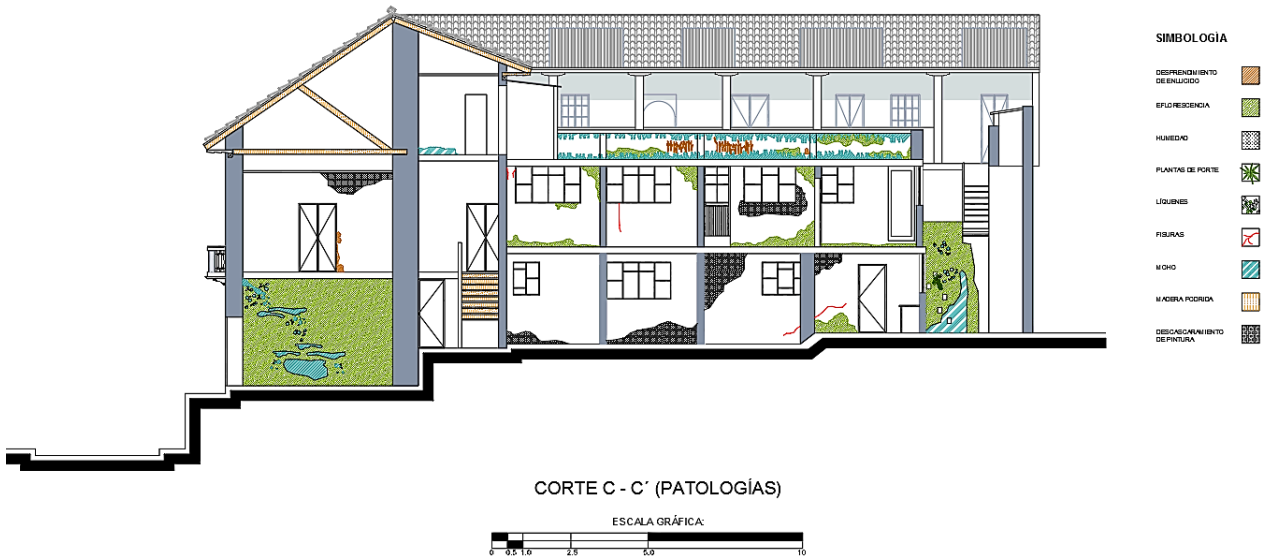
Patologías Corte C – C' • Fuente: Ilustración Propia
